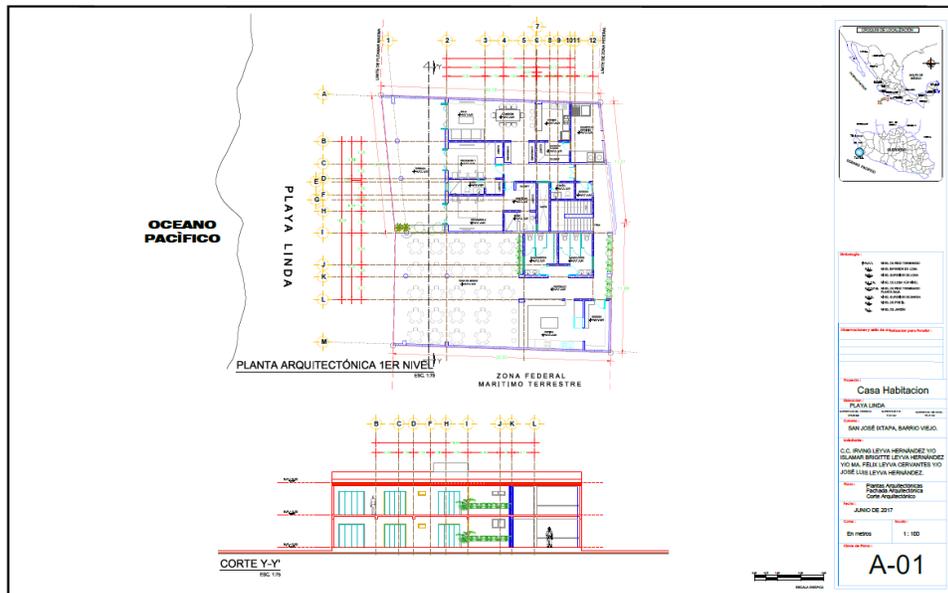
Planta arquitectónica 1er. nivel del proyecto
